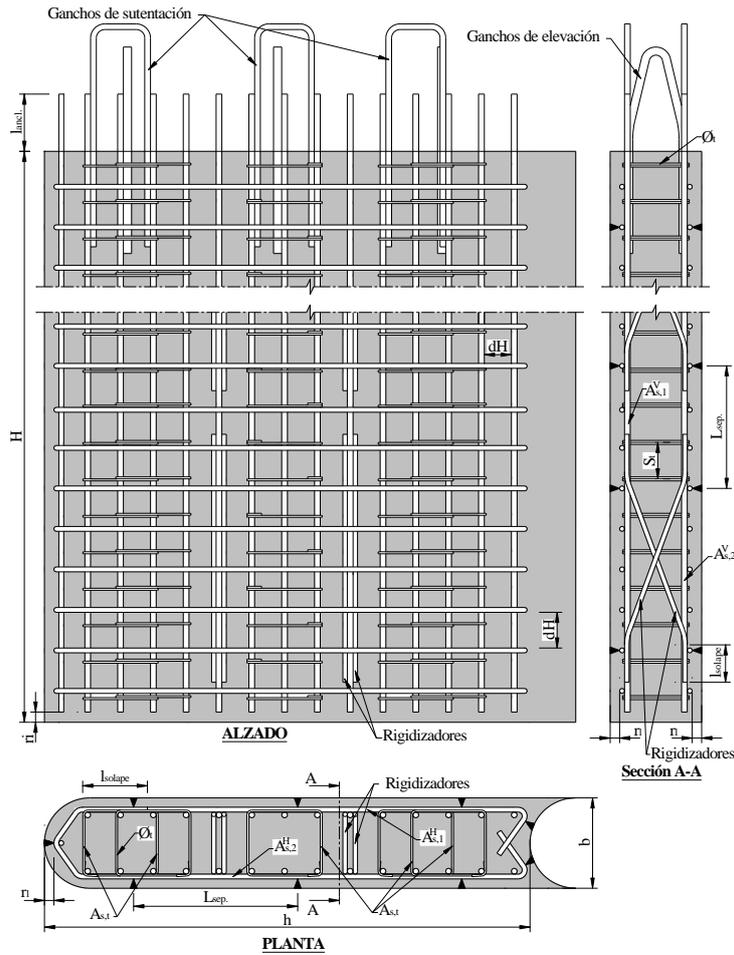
Esquema de armado de paneles de pantallas (Puede visualizarse un armado típico en el siguiente link: <https://skfb.ly/oAOxn>)
